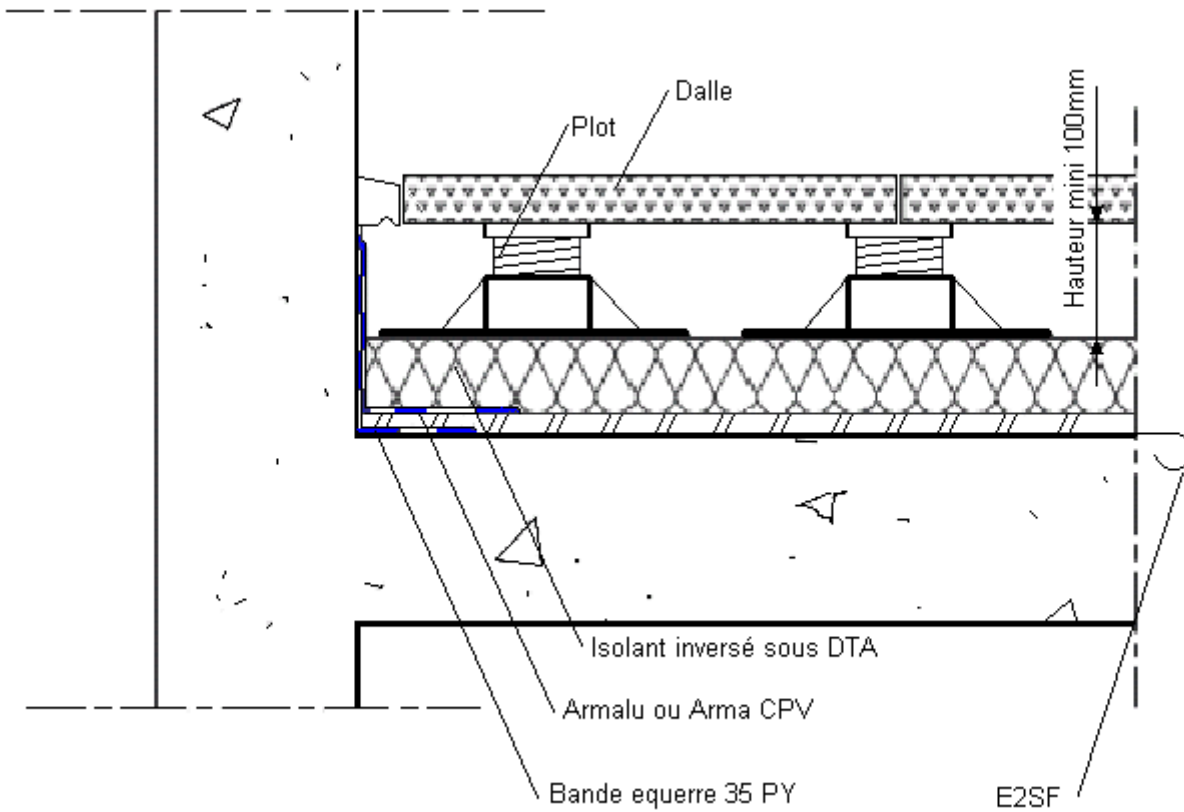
Relevé sous niveau fini des dalles - Terrasse accessible, protection par dalle sur plots
